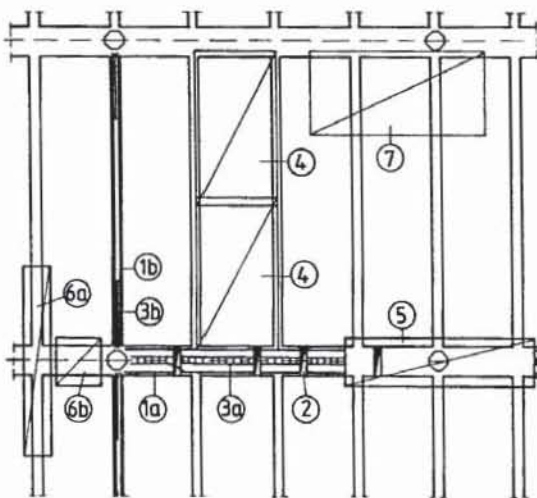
Ablaufplan für das Verlegen der „rationalisierten“ Bewehrung. 1a Hauptträgerkorb; 1b Nebenträgerkorb; 2 Aussparungen; 3a Schubzulagen (Korb); 3b Schubzulagen (Leitern); 4 Untere Deckenbewehrung; 5 Stützbewehrung Hauptträger; 6a Stützbewehrung Nebenträger; 6b Zulagematte; 7 Obere Deckenbewehrung
